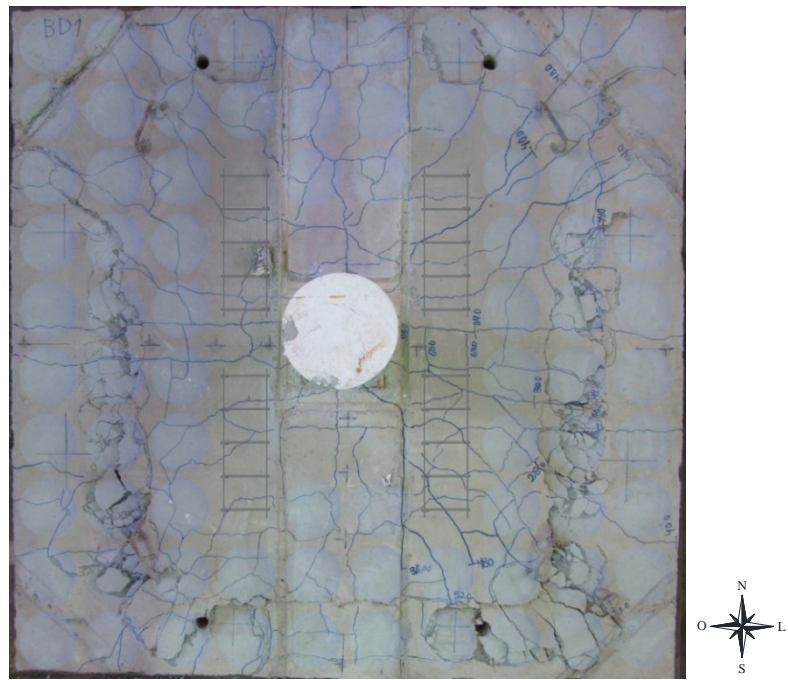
Mapa de fissuração (laje BD1)
